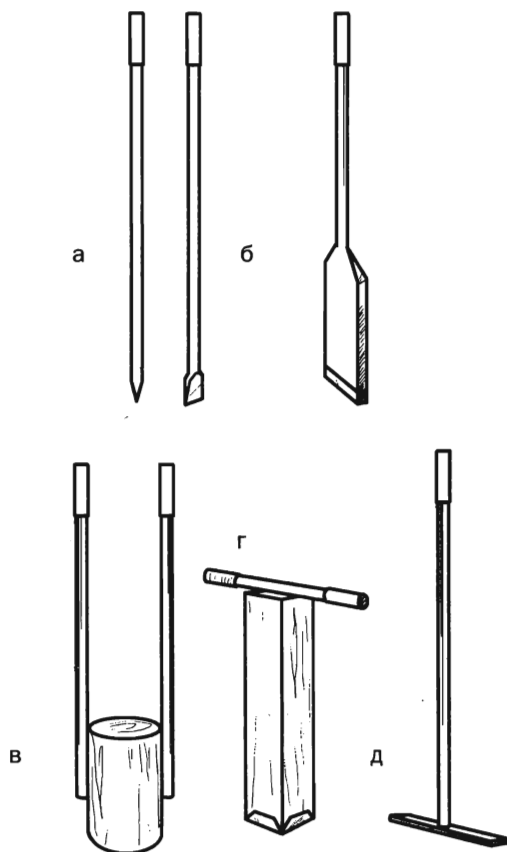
Приспособления для бетонных работ: а — щуп для штыкования; б — узкая трамбовка с металлическим уголком или п-образным профилем; в — круглая трамбовка; г — квадратная трамбовка; д — гладилка
